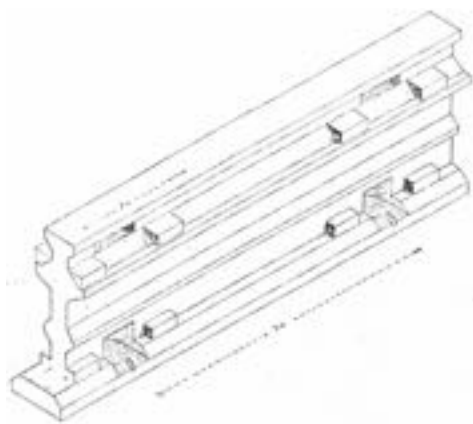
| Disegno esecutivo di travetti prefabbricati tipo "Lasize". Vista assometrica del travetto.
